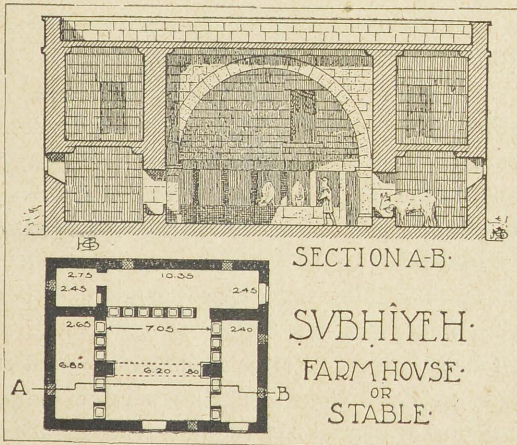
Haus in Subhije. Maßstab 1 : 500 (Grundriss) und 1 : 250 (Aufriss).
